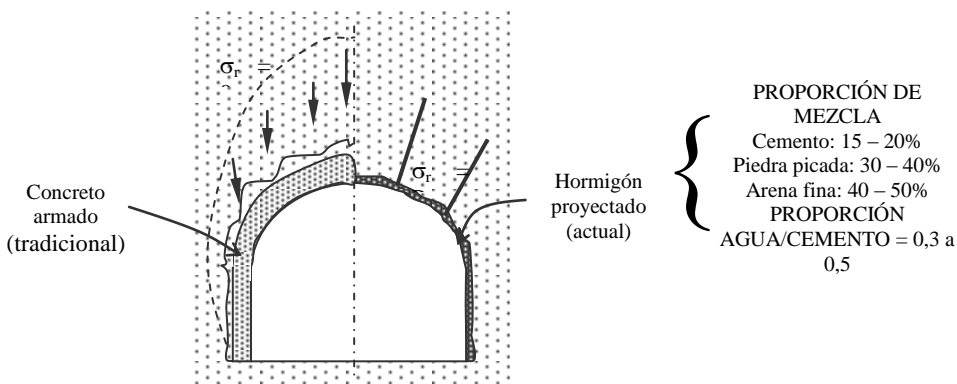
Esquema de soporte de concreto (hormigón) proyectado comparado con hormigón armado
